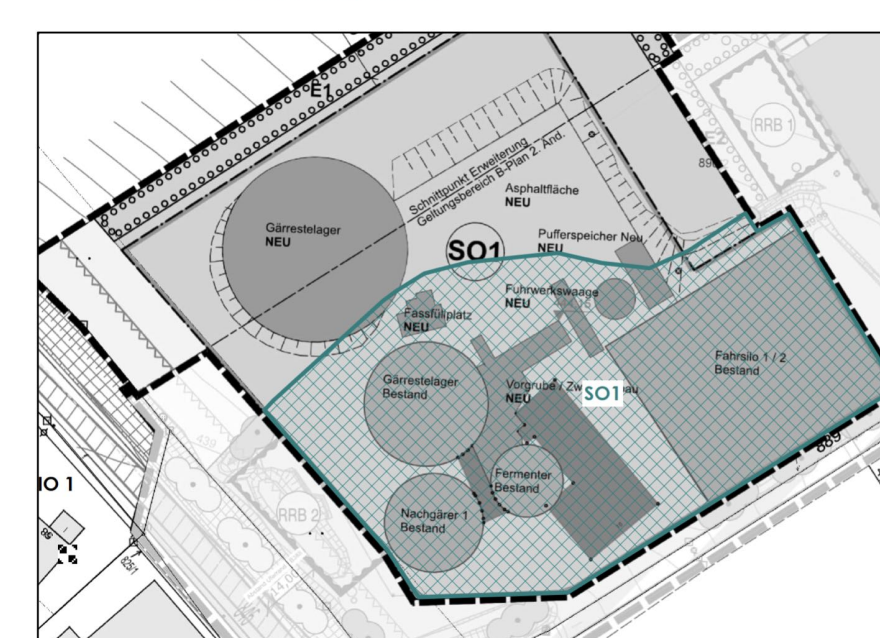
Lageplan mit Darstellung der Emissionsbezugsfläche
